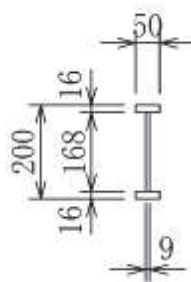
補助縦桁の断面形状 (単位: mm)
